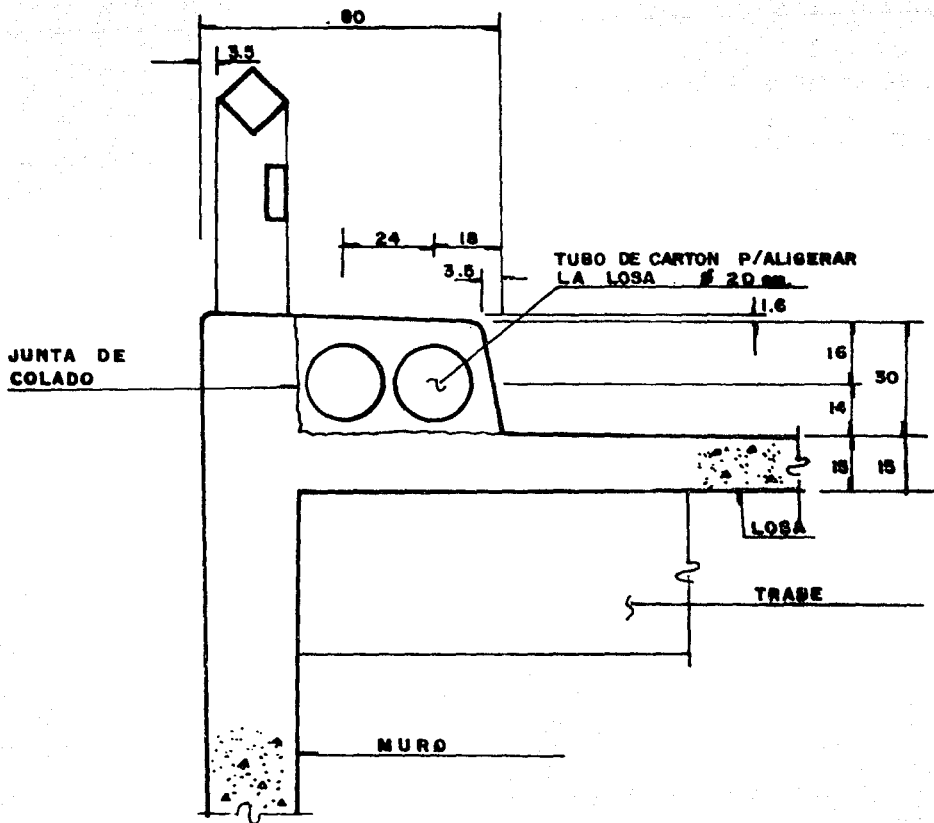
PARAPETO EN ZONA DE PUENTE.
